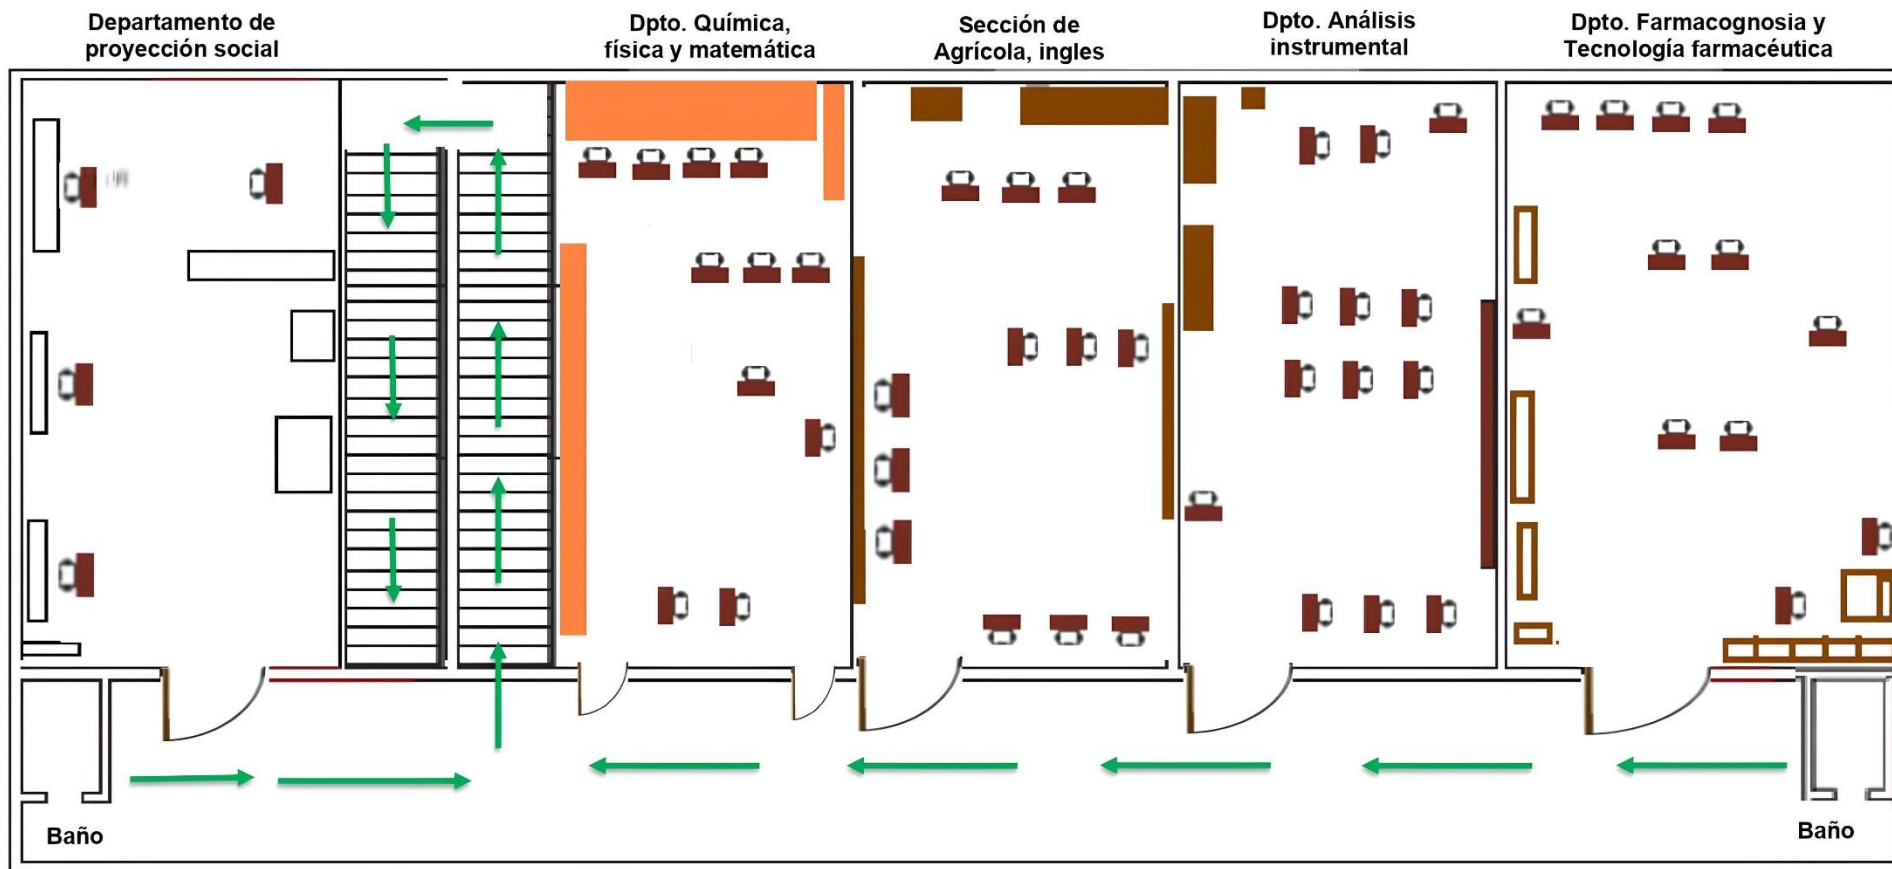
Mapa de riesgo vista en planta (sin escala) cuarta planta⁵
